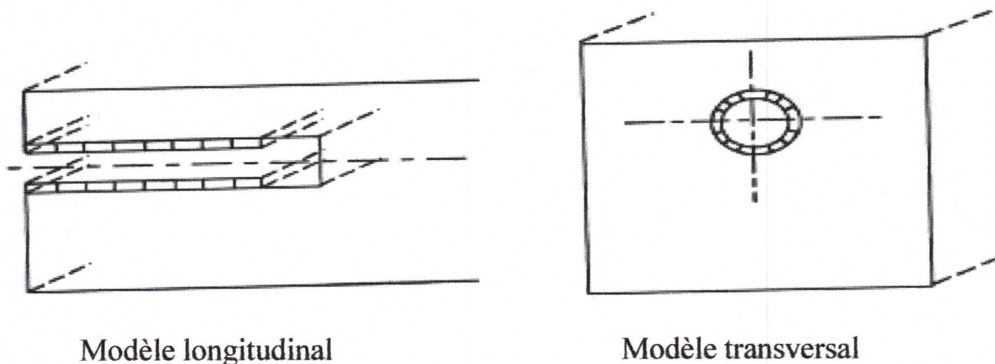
Modèle longitudinal et transversal du tunnel.
